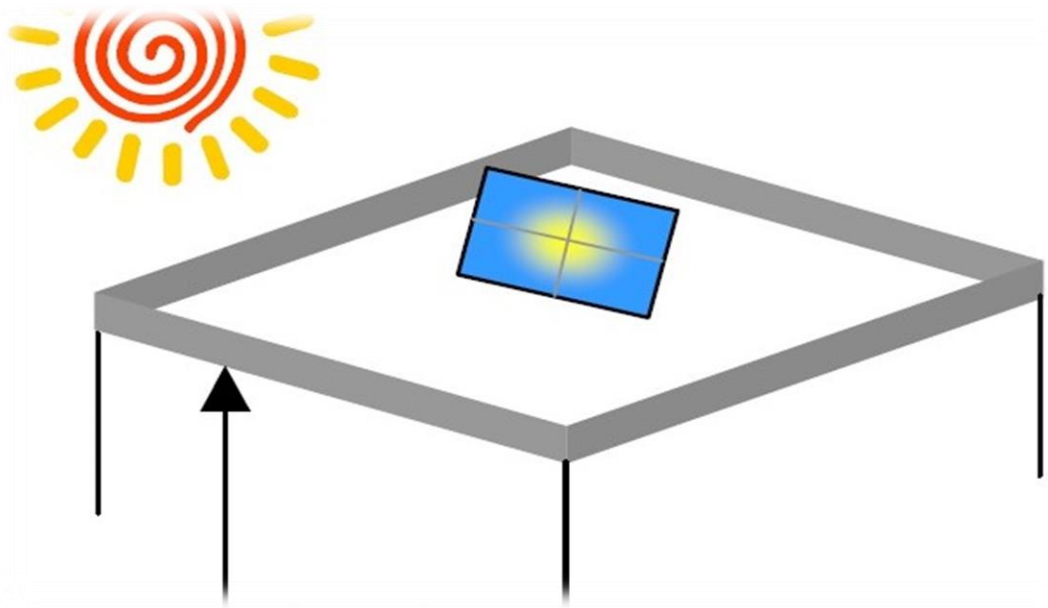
Installation des capteurs solaires sur une toiture terrasse.
